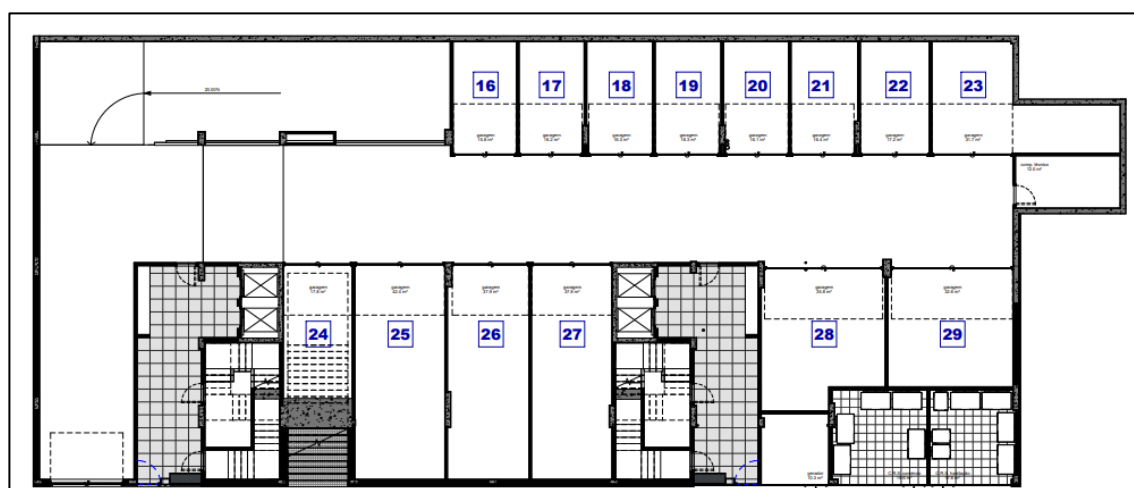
Recorte da planta de arquitetura do piso -1 do edifício Altavista 16, editado (1).
